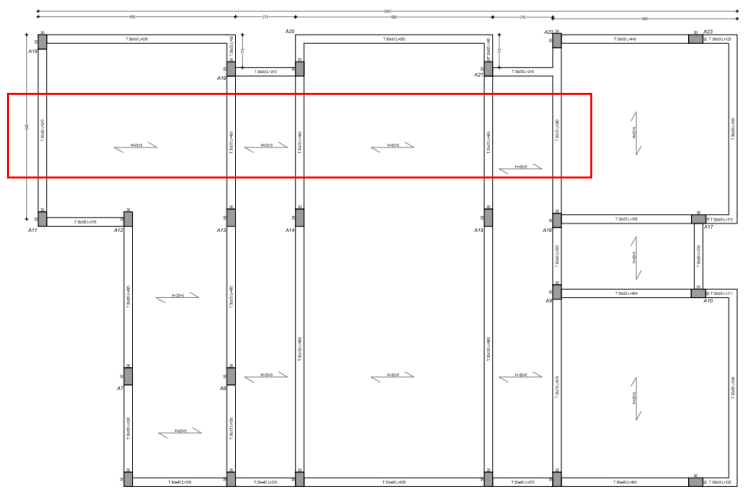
Stralcio carpenteria I Impalcato con identificazione solaio oggetto di verifica
